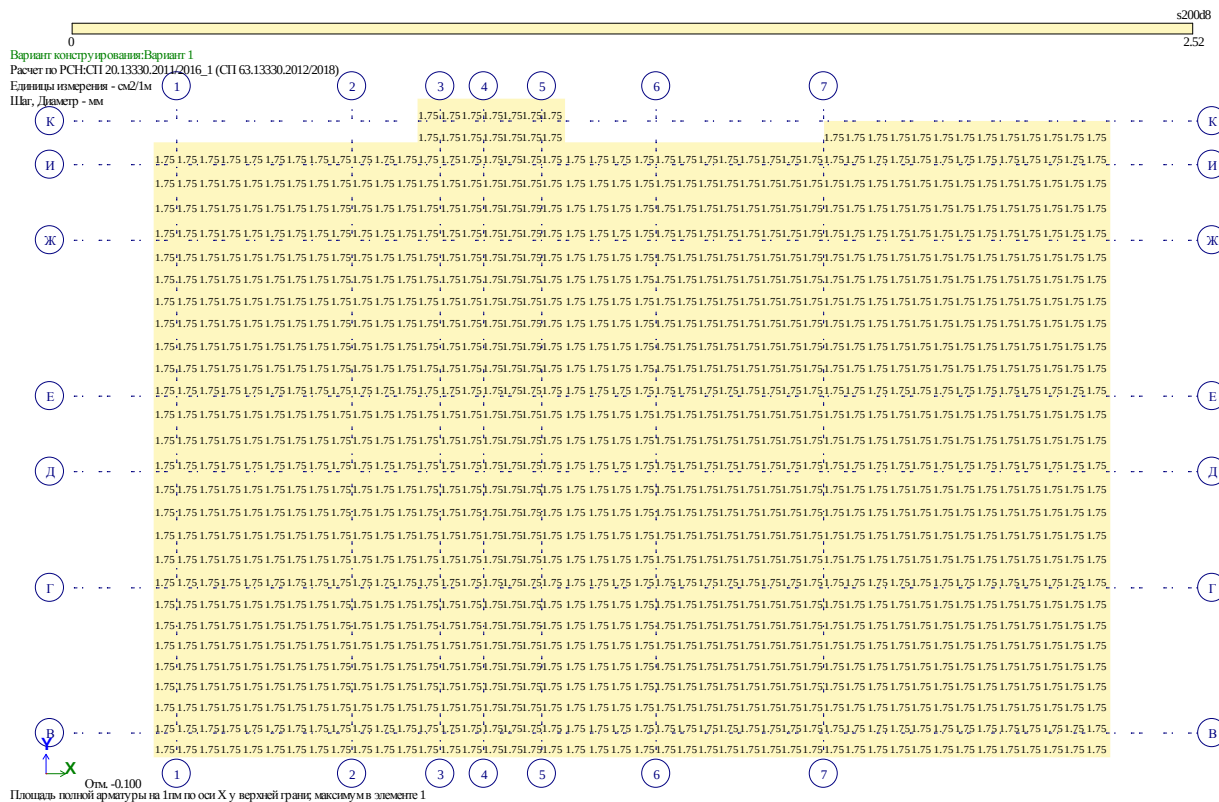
Площадь полной арматуры на 1мм по оси X у верхней грани(2)
